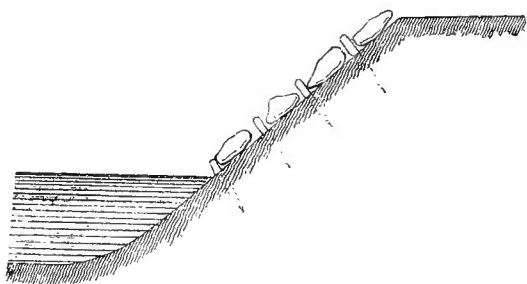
Revêtement en pierres et piquets pour consolidation de talus.
